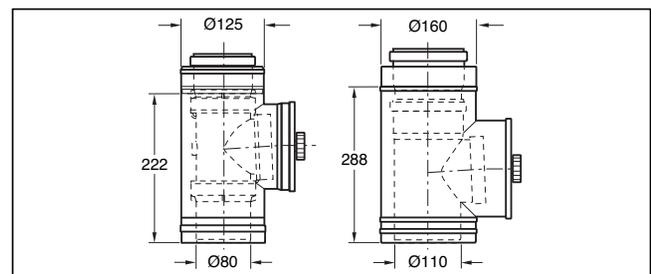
Konzentrisches Rohr mit Prüföffnung (Maße in mm)
